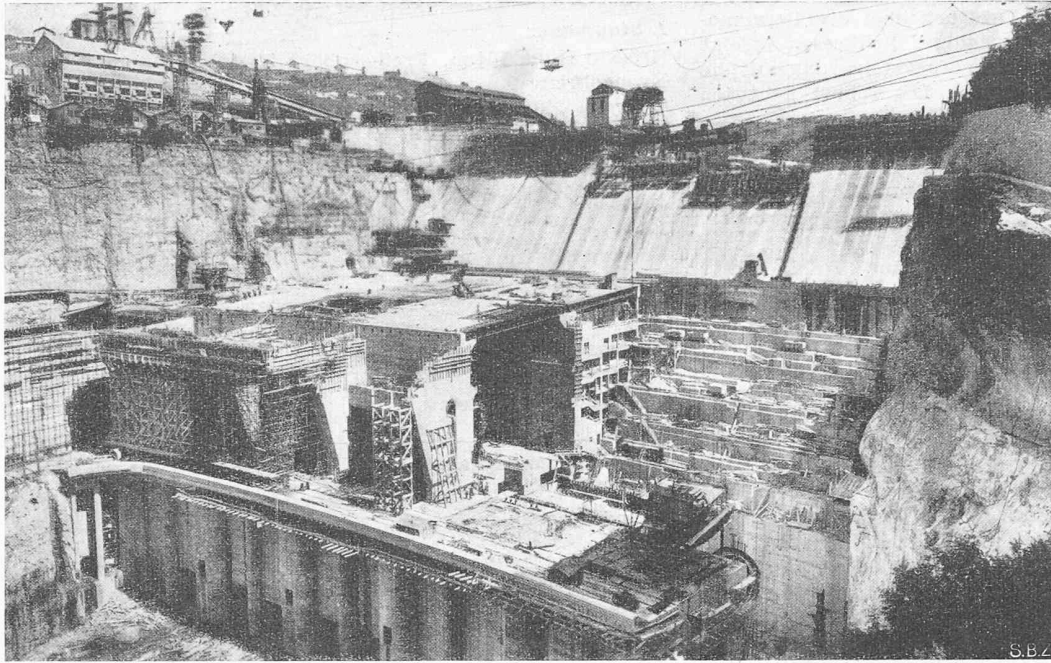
Staumauer und Zentrale im Bau, links oben die Betonfabrik
